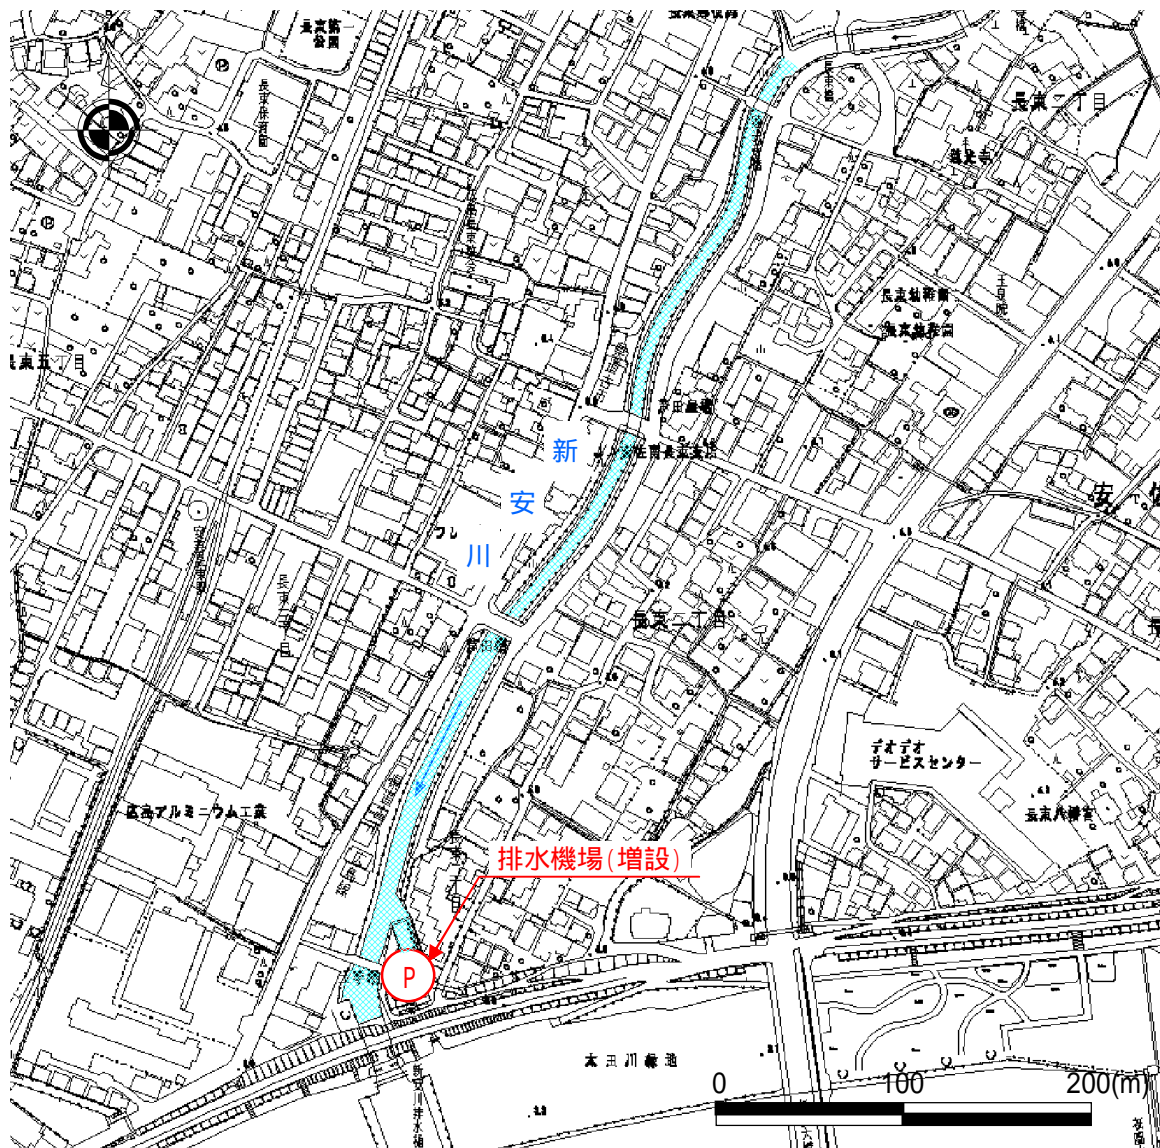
(1) 平面図(新安川) (S=1 : 4,000)
